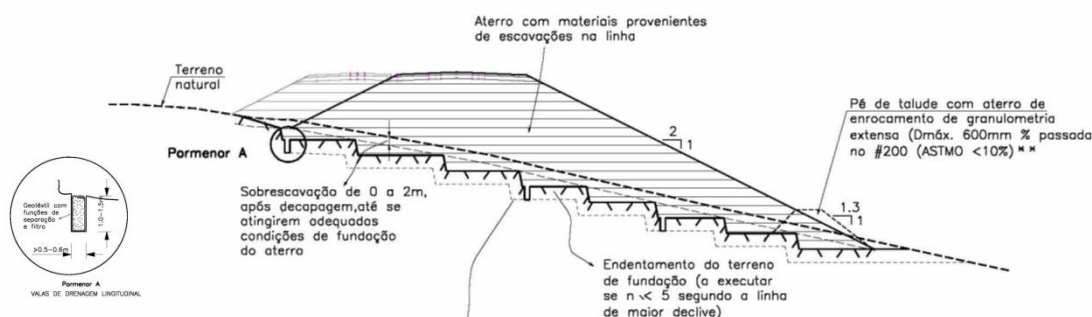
Perfil transversal tipo de aterro - endentamento e drenagem da fundação (IP, 2018)
